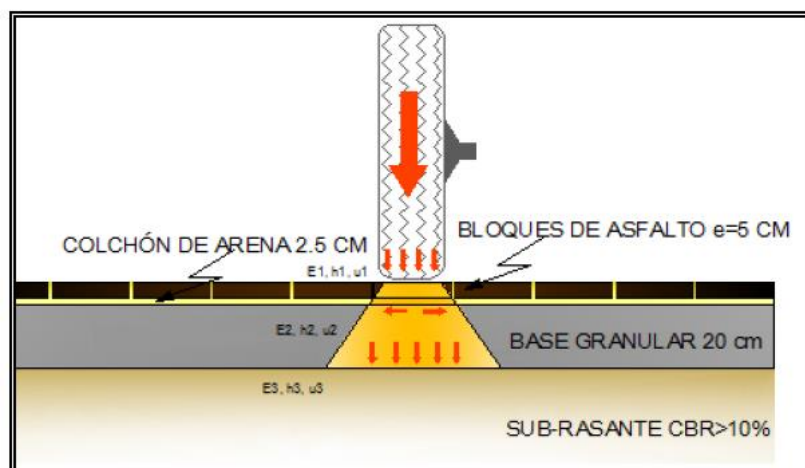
Sección Transversal Propuesta de Pavimento Articulado para Vías de Bajo Volumen de Tránsito
